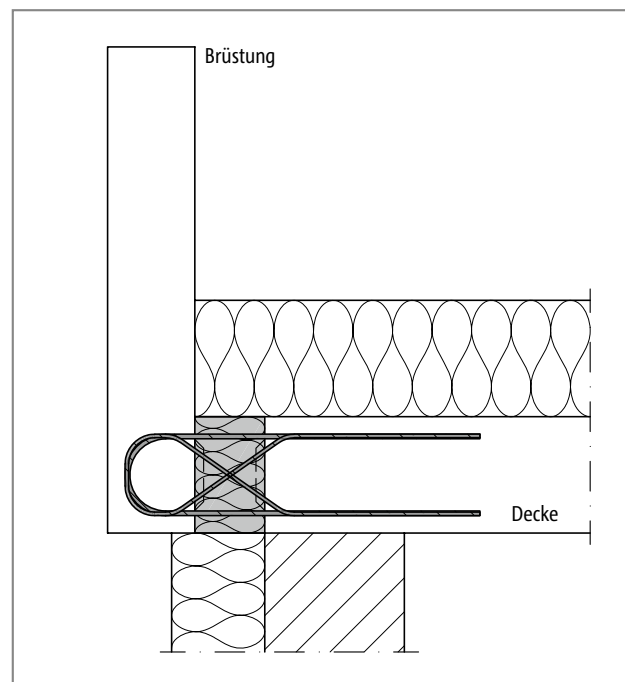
Schöck Isokorb® XT Typ AP horizontale Anordnung: Anschluss einer Brüstung
